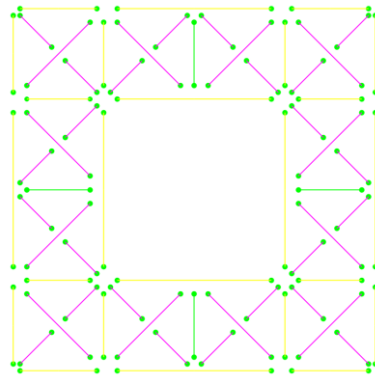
a Planta de piso “tipo”, incluyendo la disposición de los arrostramientos de piso con posición y conectividad [elaboración propia]
